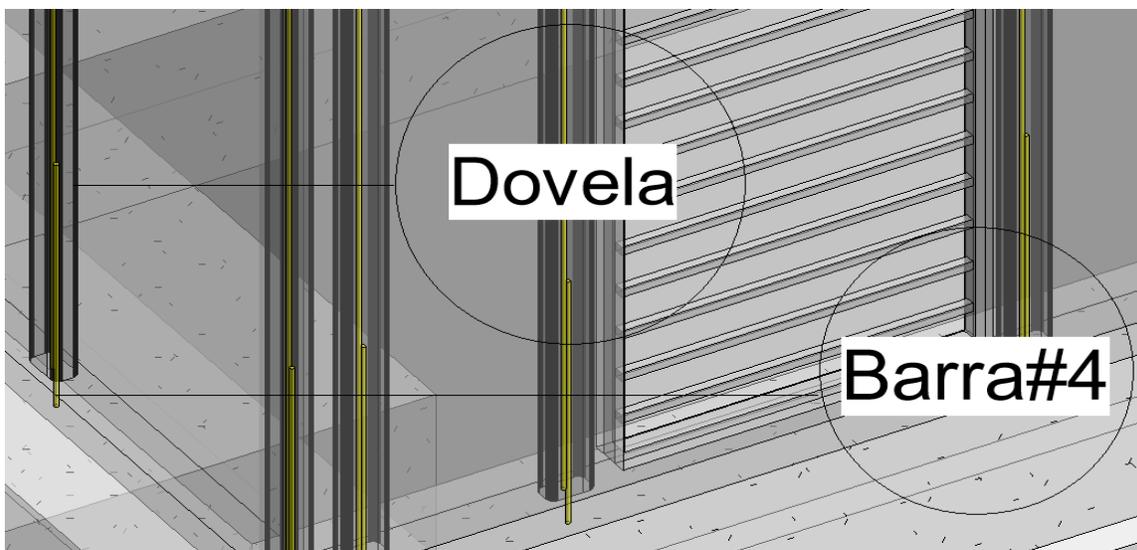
Detalle dovela en modulación de la mampostería bloque 1 cocina – comedor.
